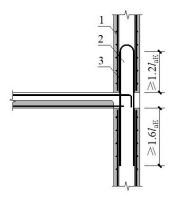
密拼接预制墙竖向分布钢筋连接构造示意
